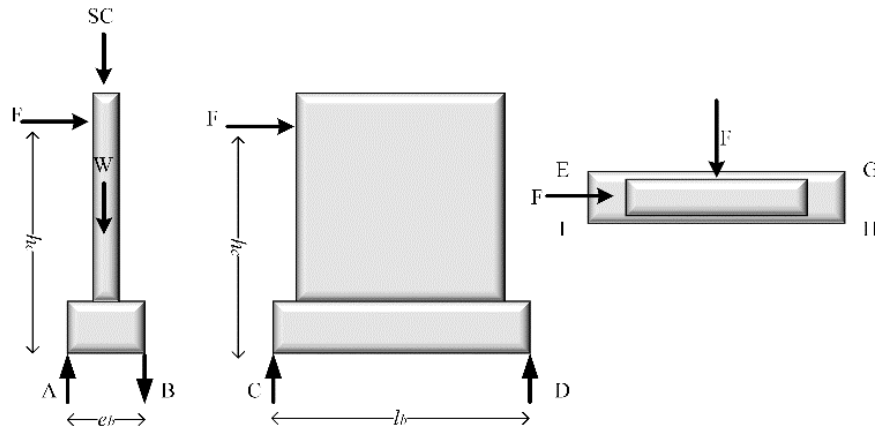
Vista frontal, lateral y en planta del muro ensayado y distribución de esfuerzo en la losa de reacción.
